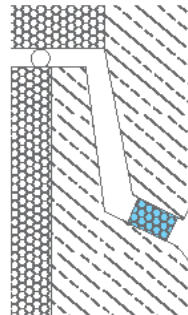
Horizontale dichtingen tussen geprefabriceerde panelen in beton
